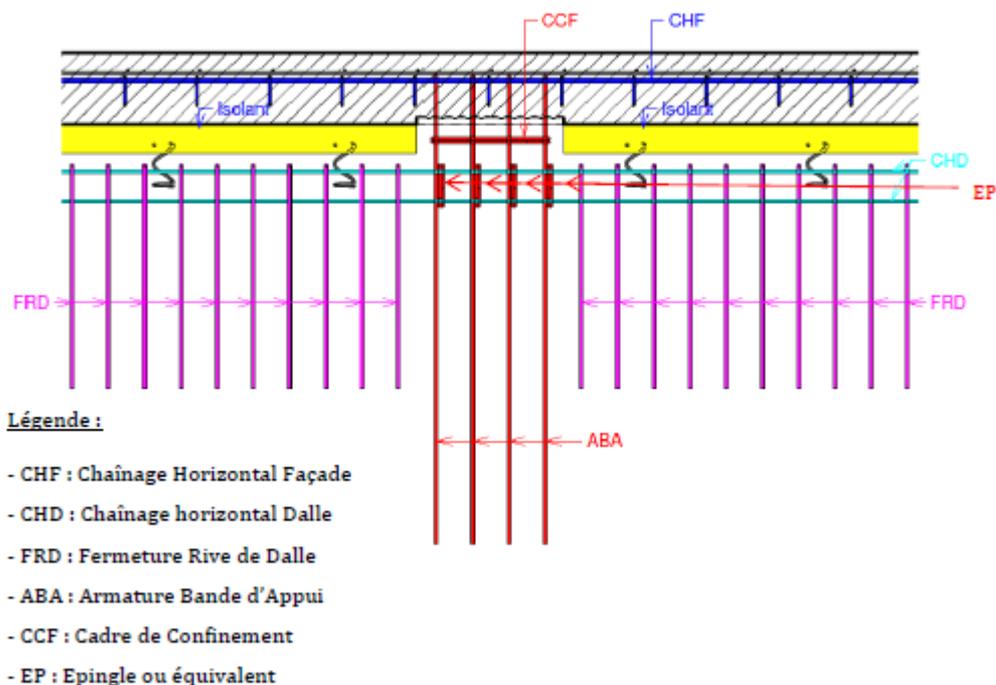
DTPTiS : Vue en plan et exemple de ferrailage
